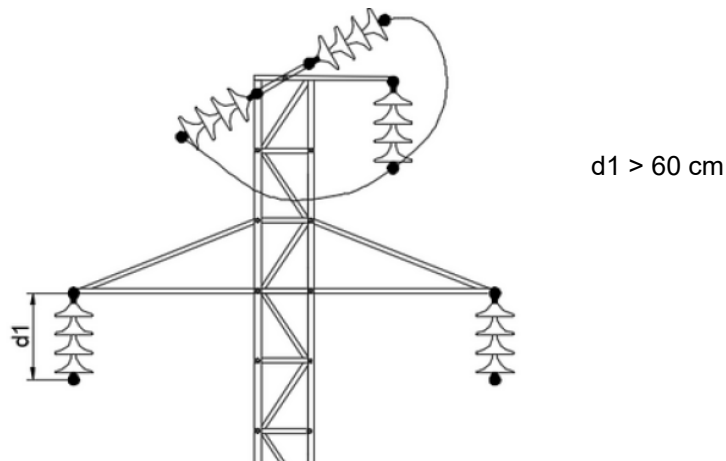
Montaje en 1 con cadenas de aisladores en suspensión
